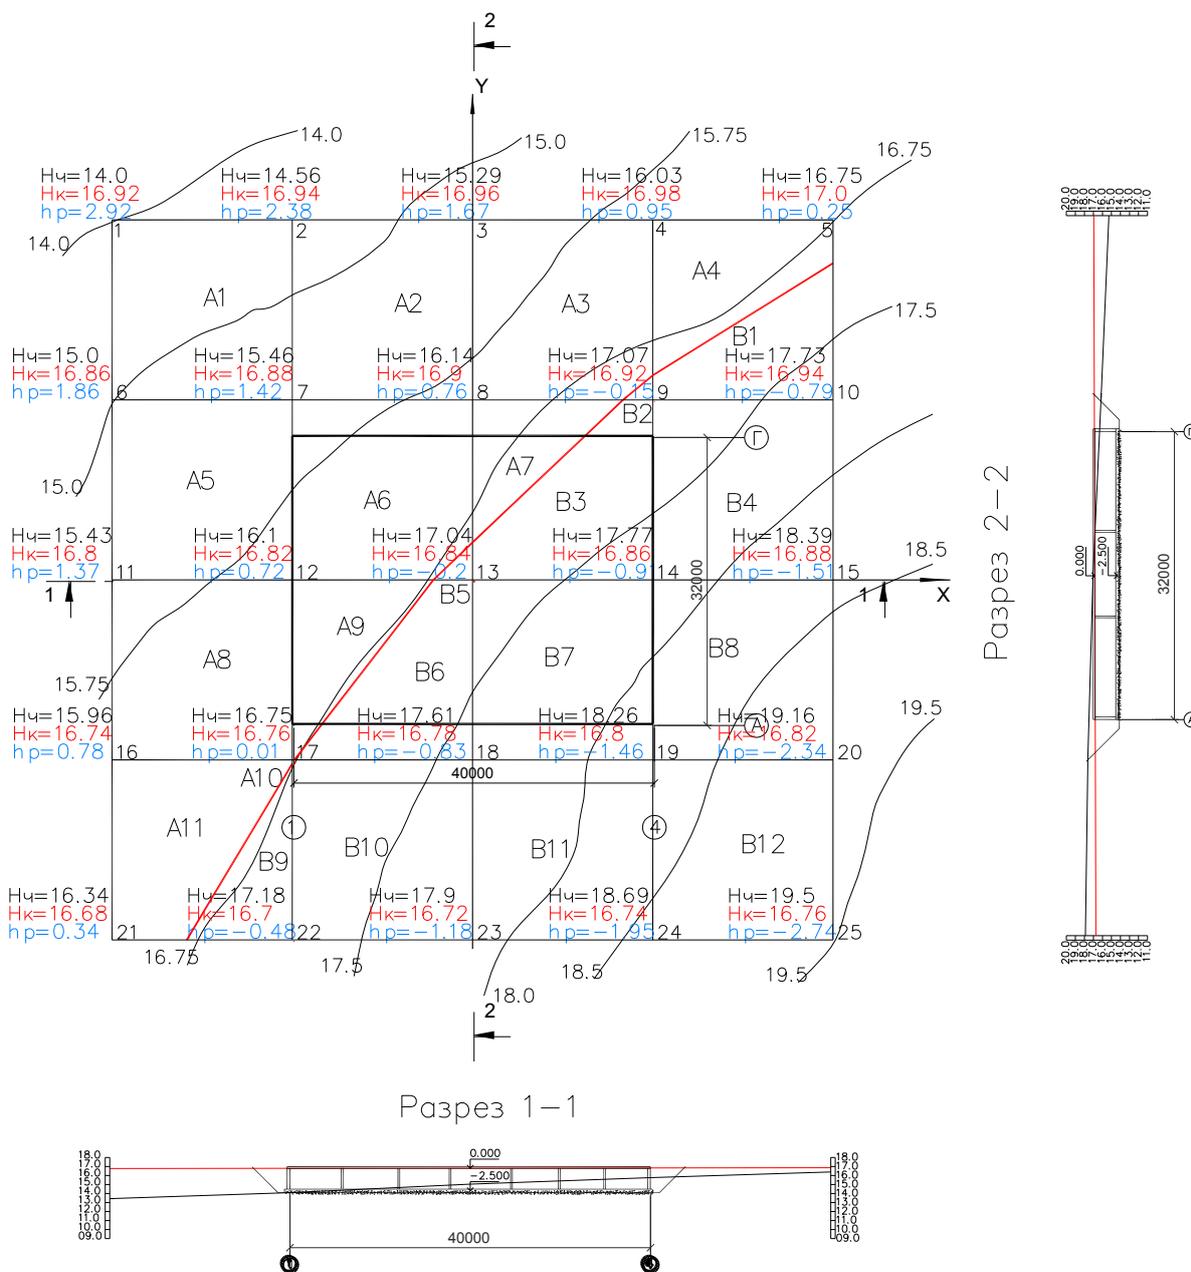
Принципиальная схема компоновки здания и квадратов сетки на плане строительной площадке
